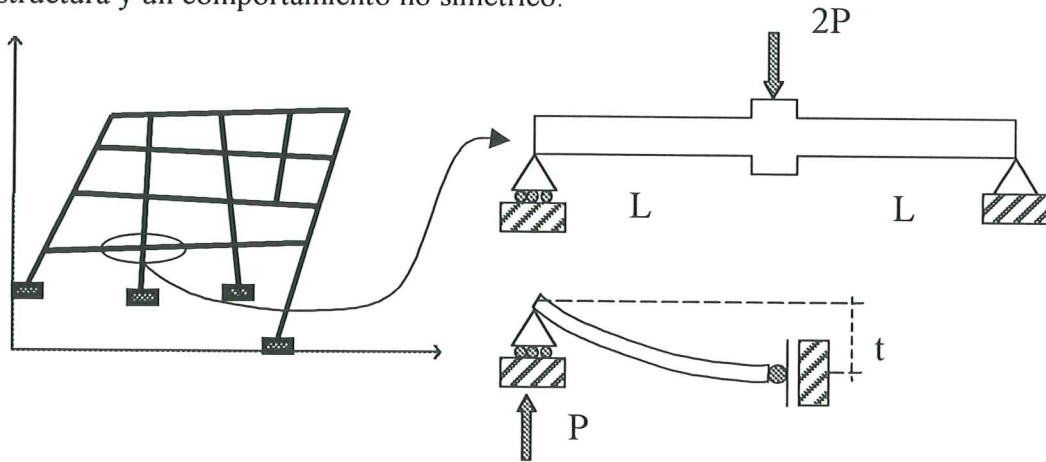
Junta viga-columna para la identificación de la resistencia al agrietamiento.
